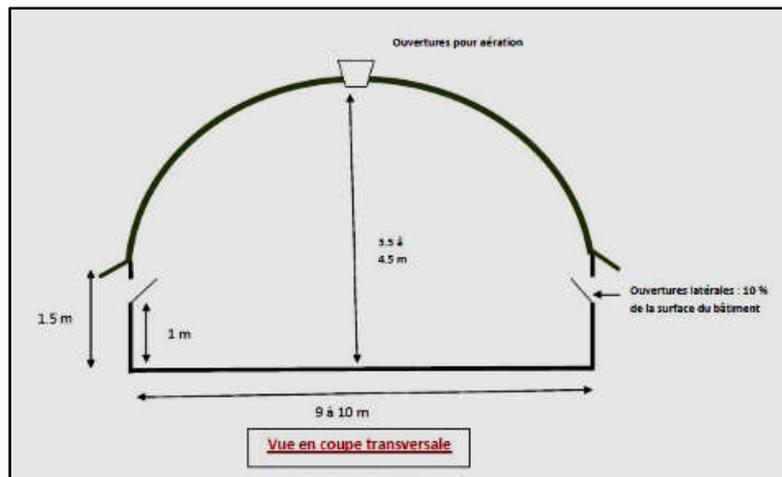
Plan d'un bâtiment poulet de chair (19).
